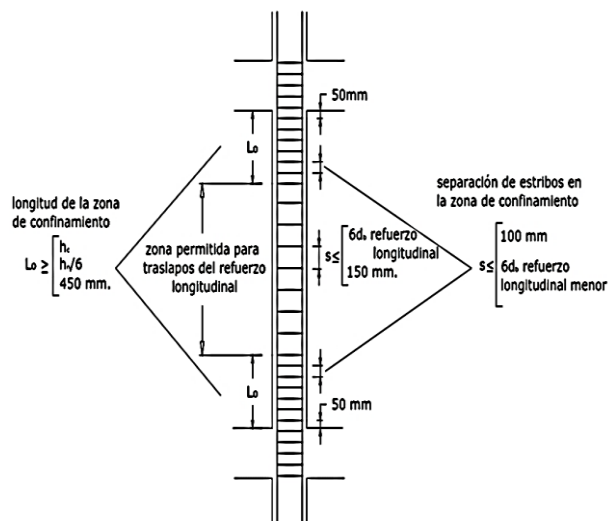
Separación de estribos en columnas según la NEC-SE – HM. [12]
